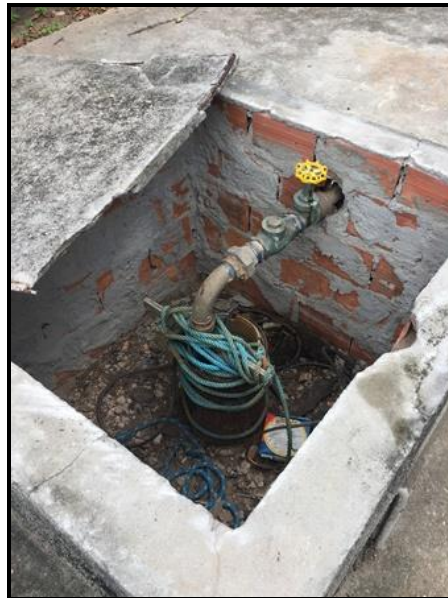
Poço - Povoado Cerquinha das Laranjas
